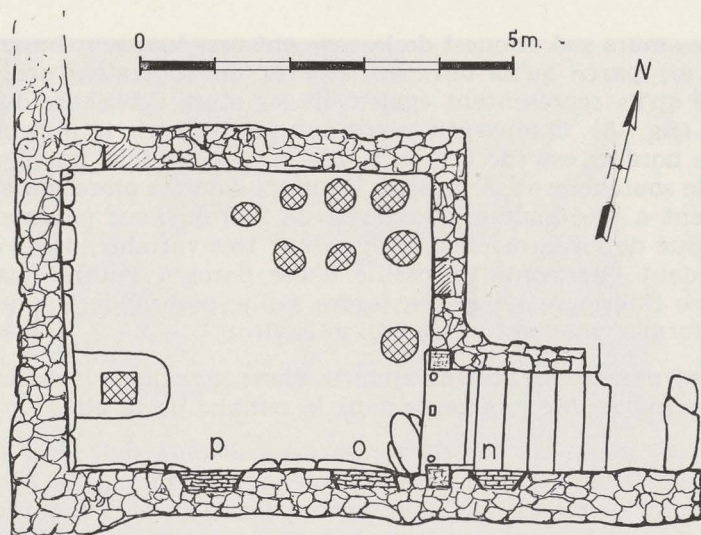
Plan de la cave C 1 avec taches foncées sur le sol.
